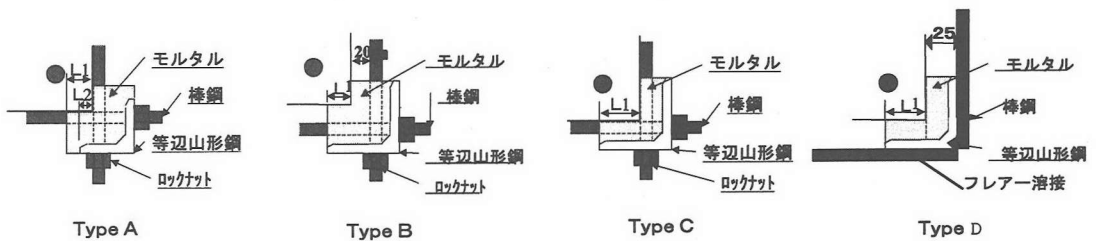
耐震補強試験体の補強鉄筋定着部詳細図
